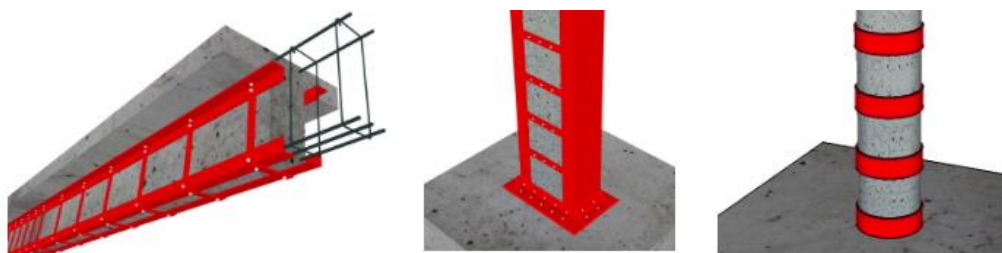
Exemplo ilustrativo de reforço de vigas e pilares com recurso a chapas ou perfis de aço (Chastre, 2014).
